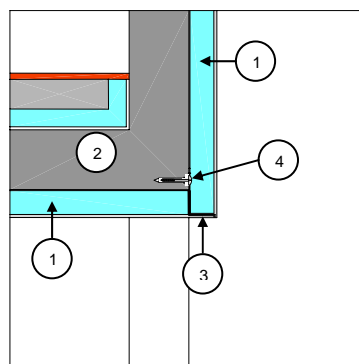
Sezione verticale su piloties (1:isolante; 2:solaio; 3:profilo con gocciolatoio; 4:vite con tassello)
